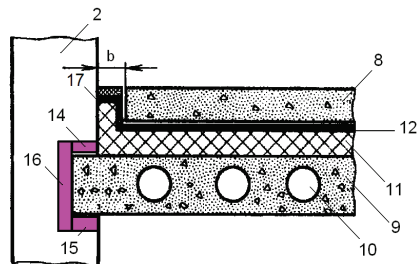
Фрагмент междуэтажного перекрытия здания в разрезе.
